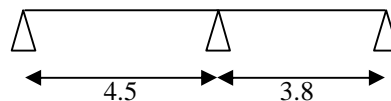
Schéma du 2<sup>eme</sup> type de poutrelle
